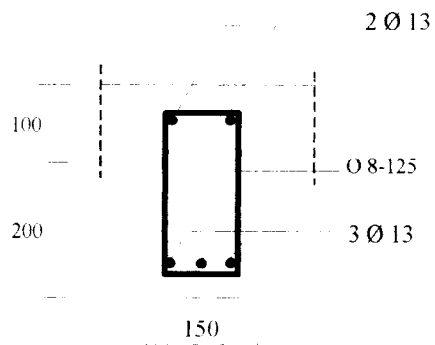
Rencana Penulangan Balok Anak Lantai 2 dan 3
